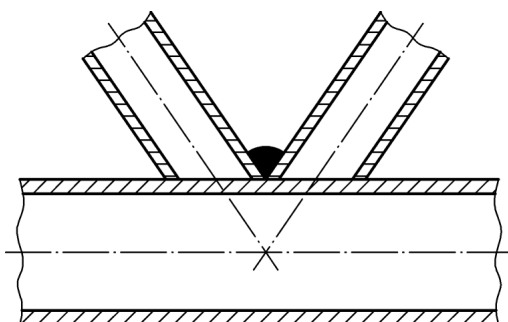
Підготовка та підгонка контурів зварного шва порожнистого профілю для стикових з'єднань під кутом
